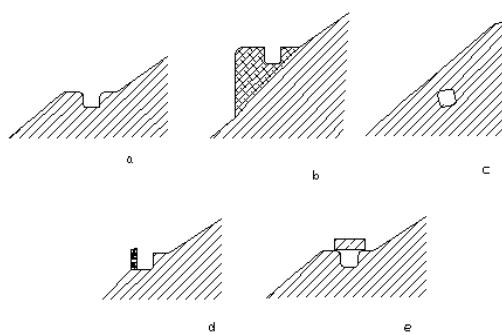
Tipos construtivos dos aquedutos. a) escavado na própria rocha; b) sustentado por muros de pedra seca c) em galerias; d) paredes laterais; e) com estrutura de proteção (Sobreira *et al.* 2005b)
